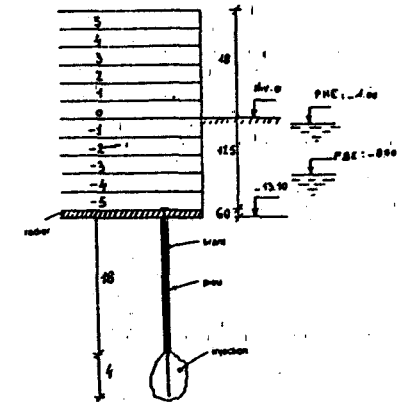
Coupe verticale du bâtiment fondé sur pieux
